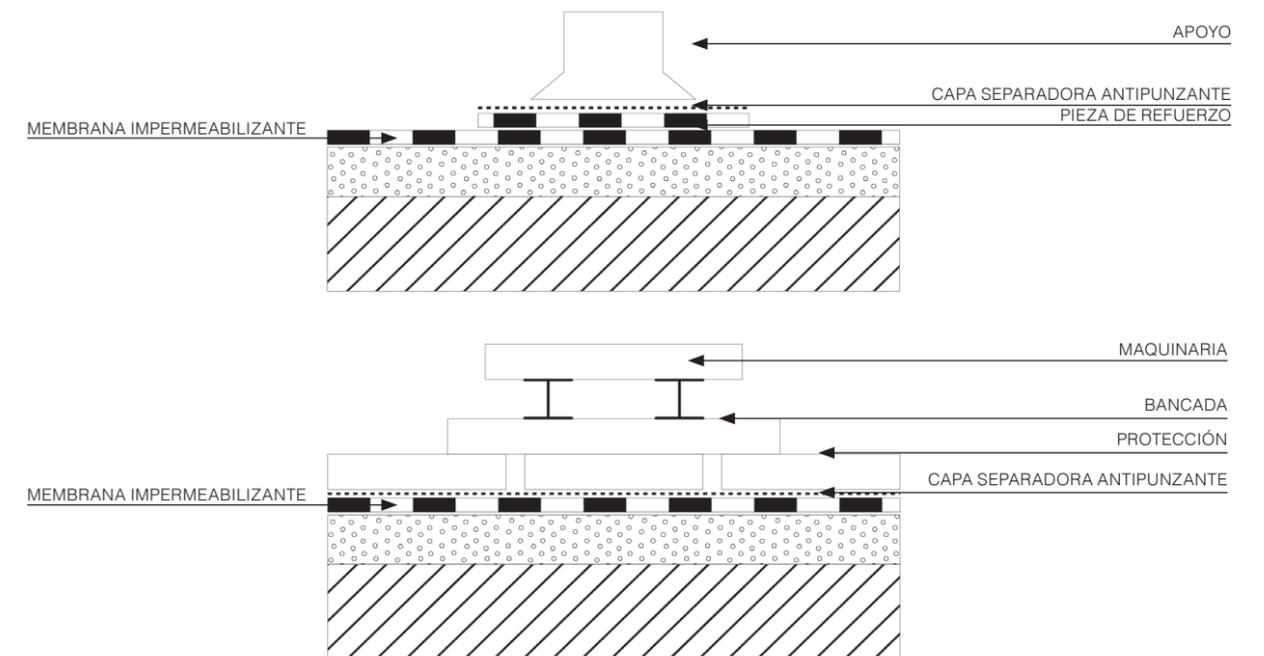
Detalles de apoyos de instalaciones sobre la cubierta
